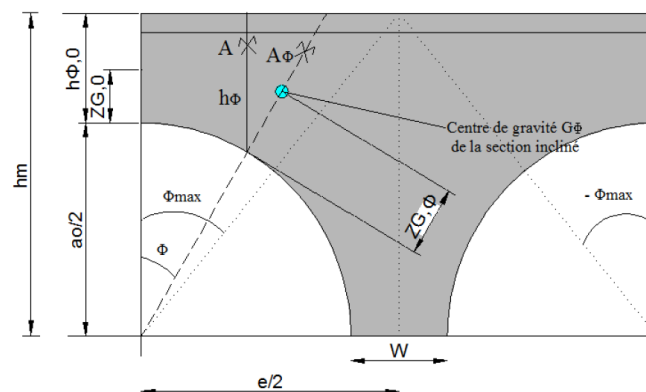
section inclinée à l'endroit d'une ouverture[5].
